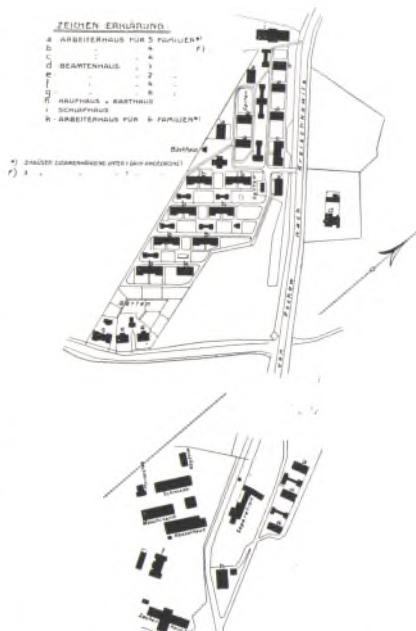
Kolonie der Annagrube bei Pschow. Lageplan.
